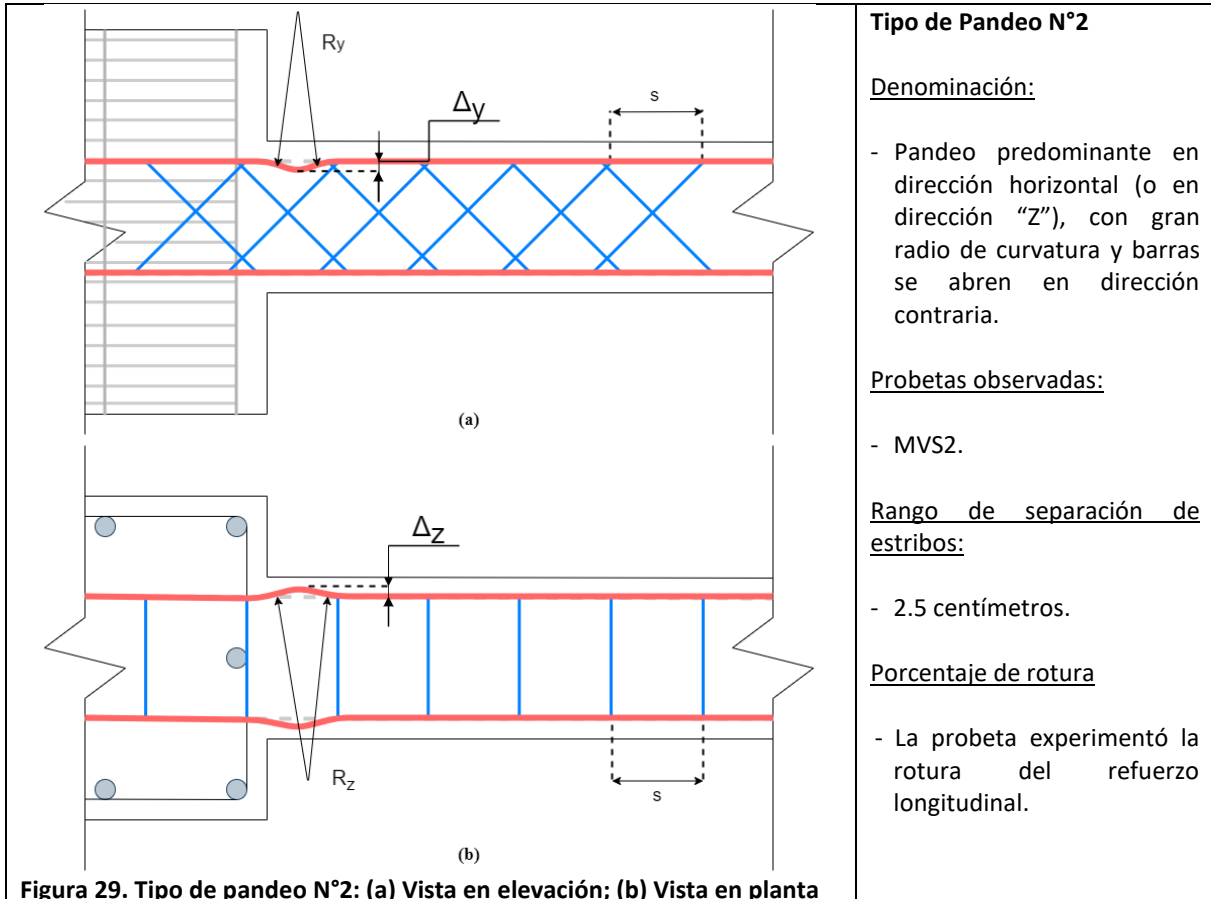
Tipo de pandeo N°2: (a) Vista en elevación; (b) Vista en planta
